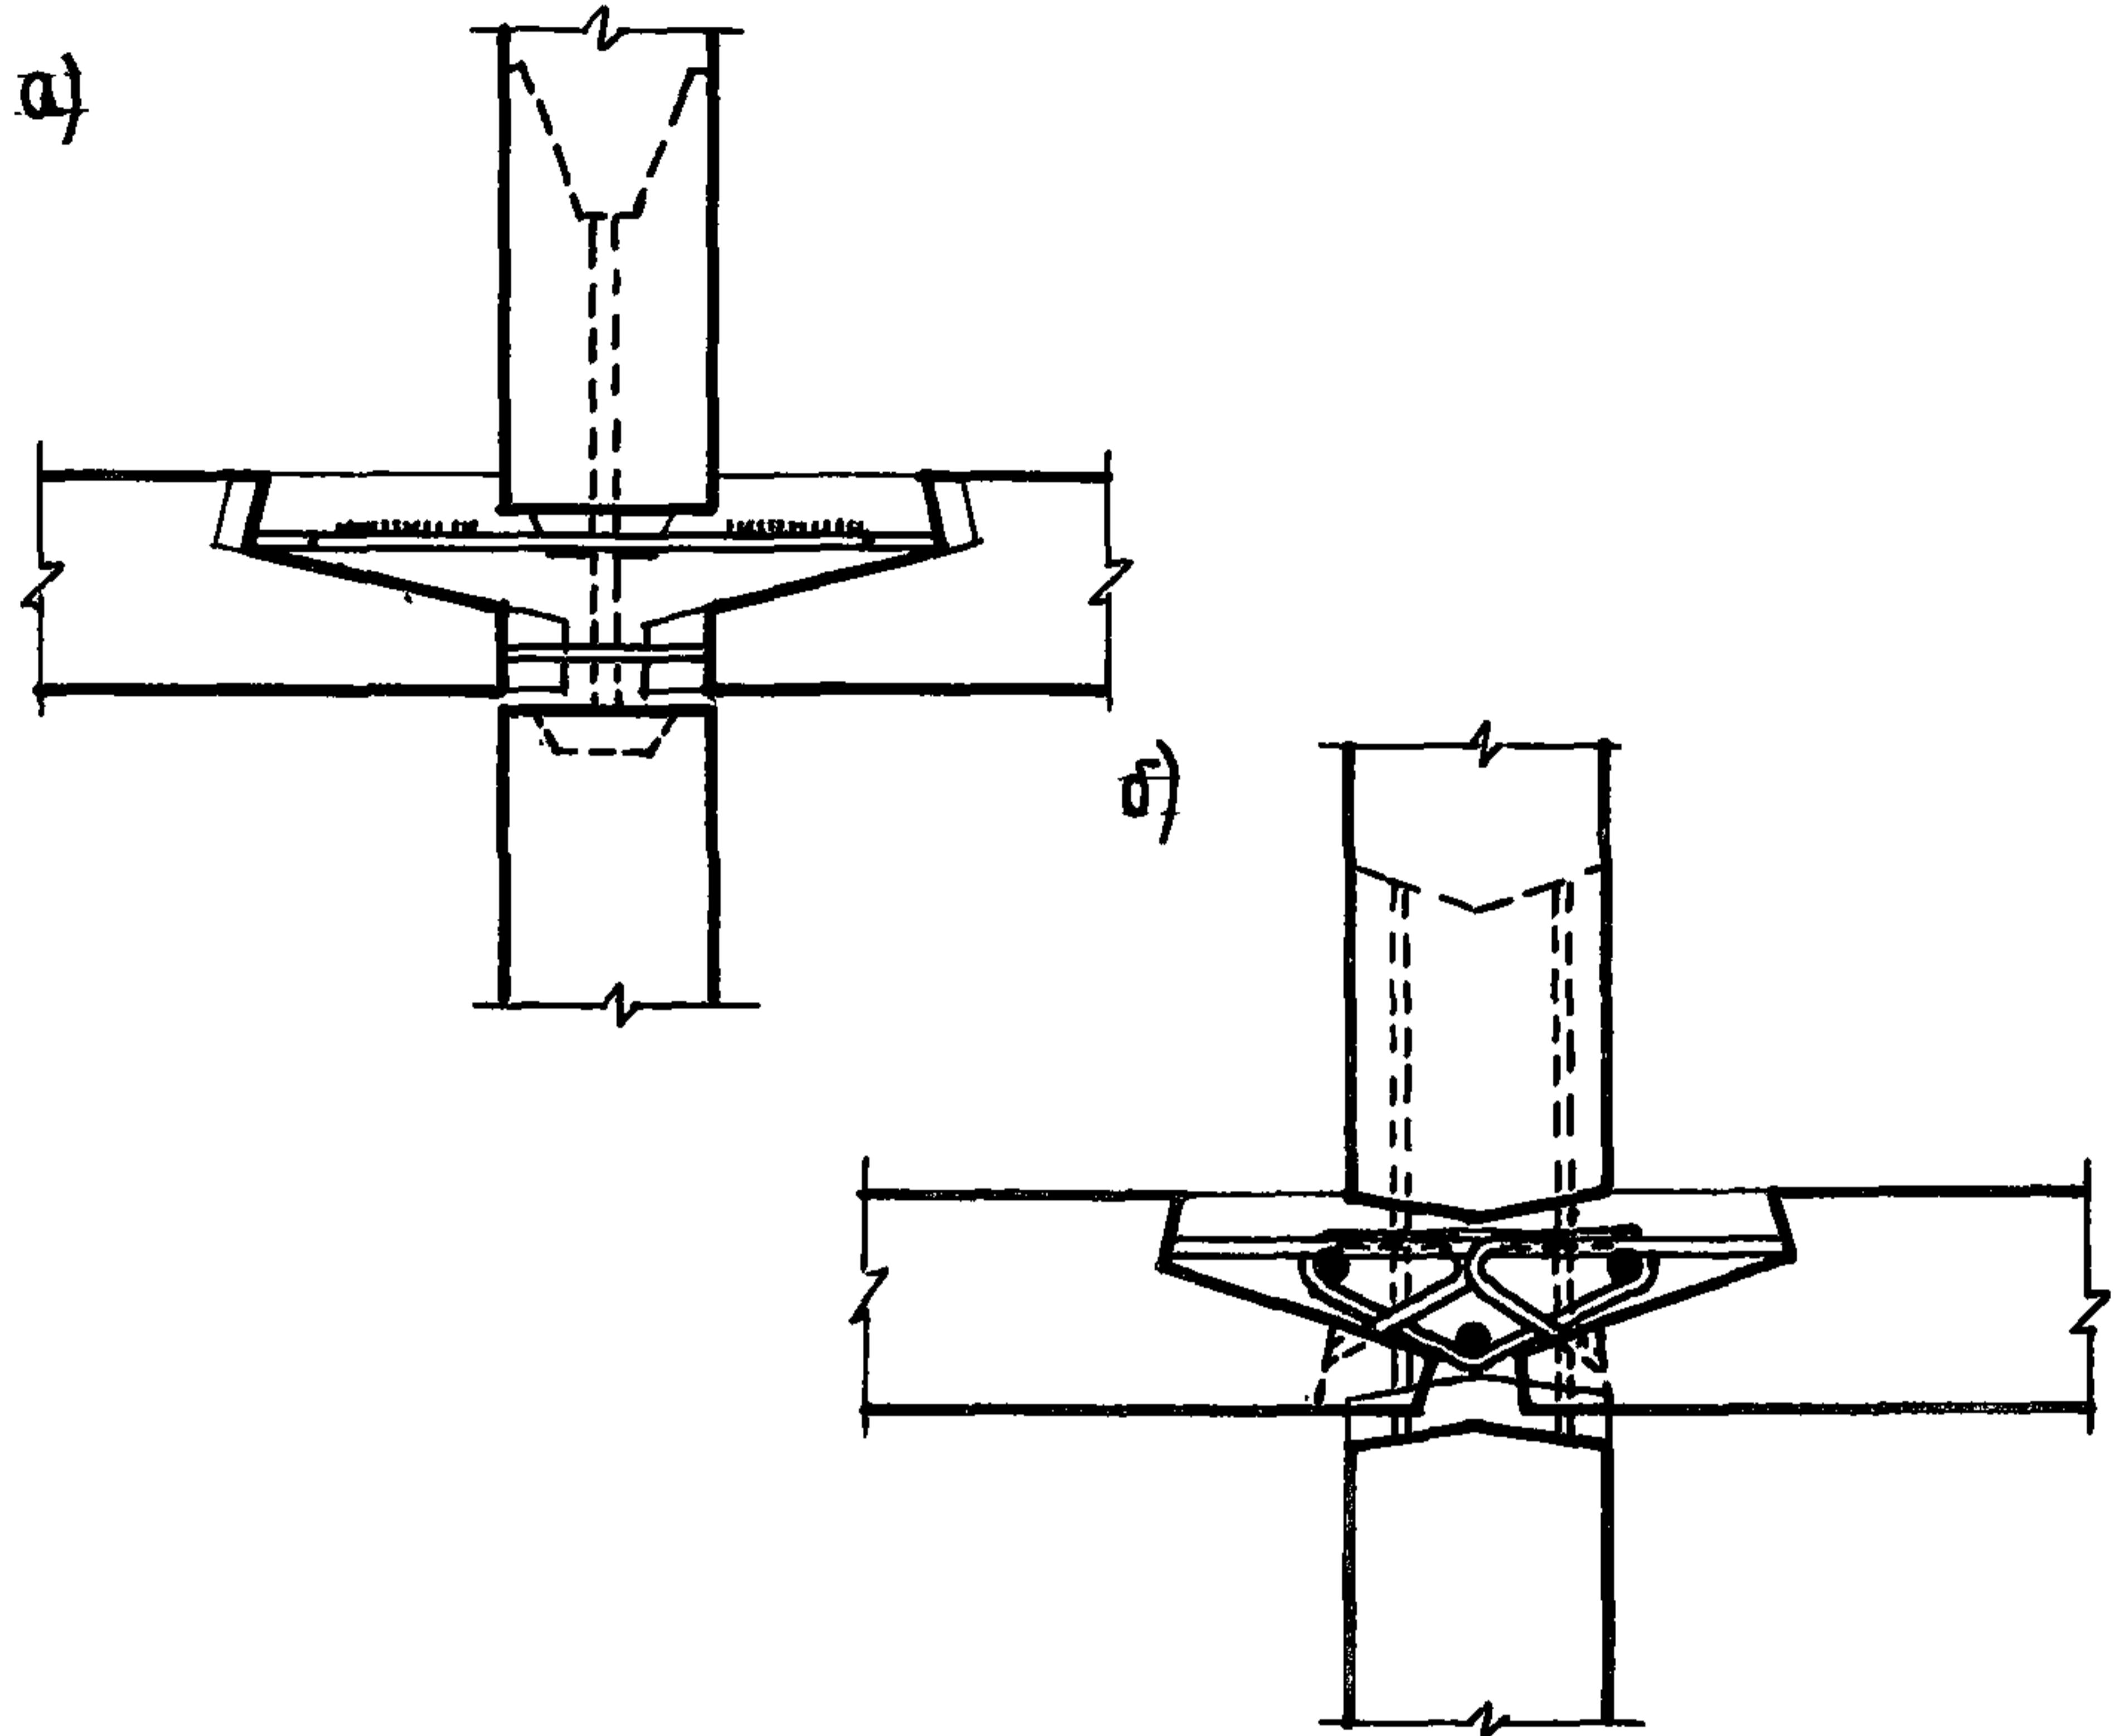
Монолитные горизонтальныестыки стен с плитами перекрытий сплошного сечения (опыт СПР): а – сварные связи плит перекрытия; б – петлевые связи плит перекрытия
